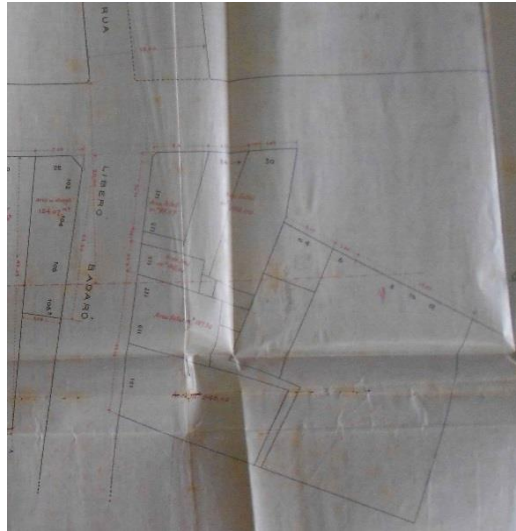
Pormenor da planta acima, no trecho entre a Rua Líbero Badaró e o Ribeirão Anhangabaú. Fonte: SIURB.
